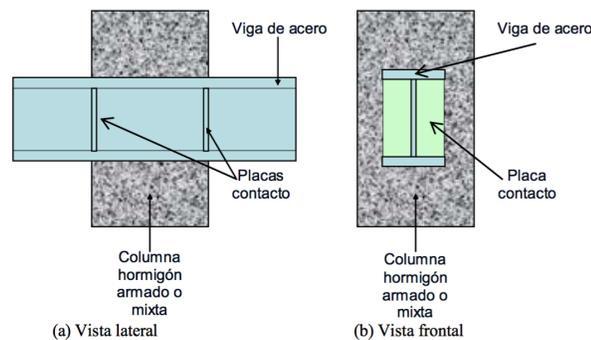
Conexión viga de acero a columna de hormigón armado
